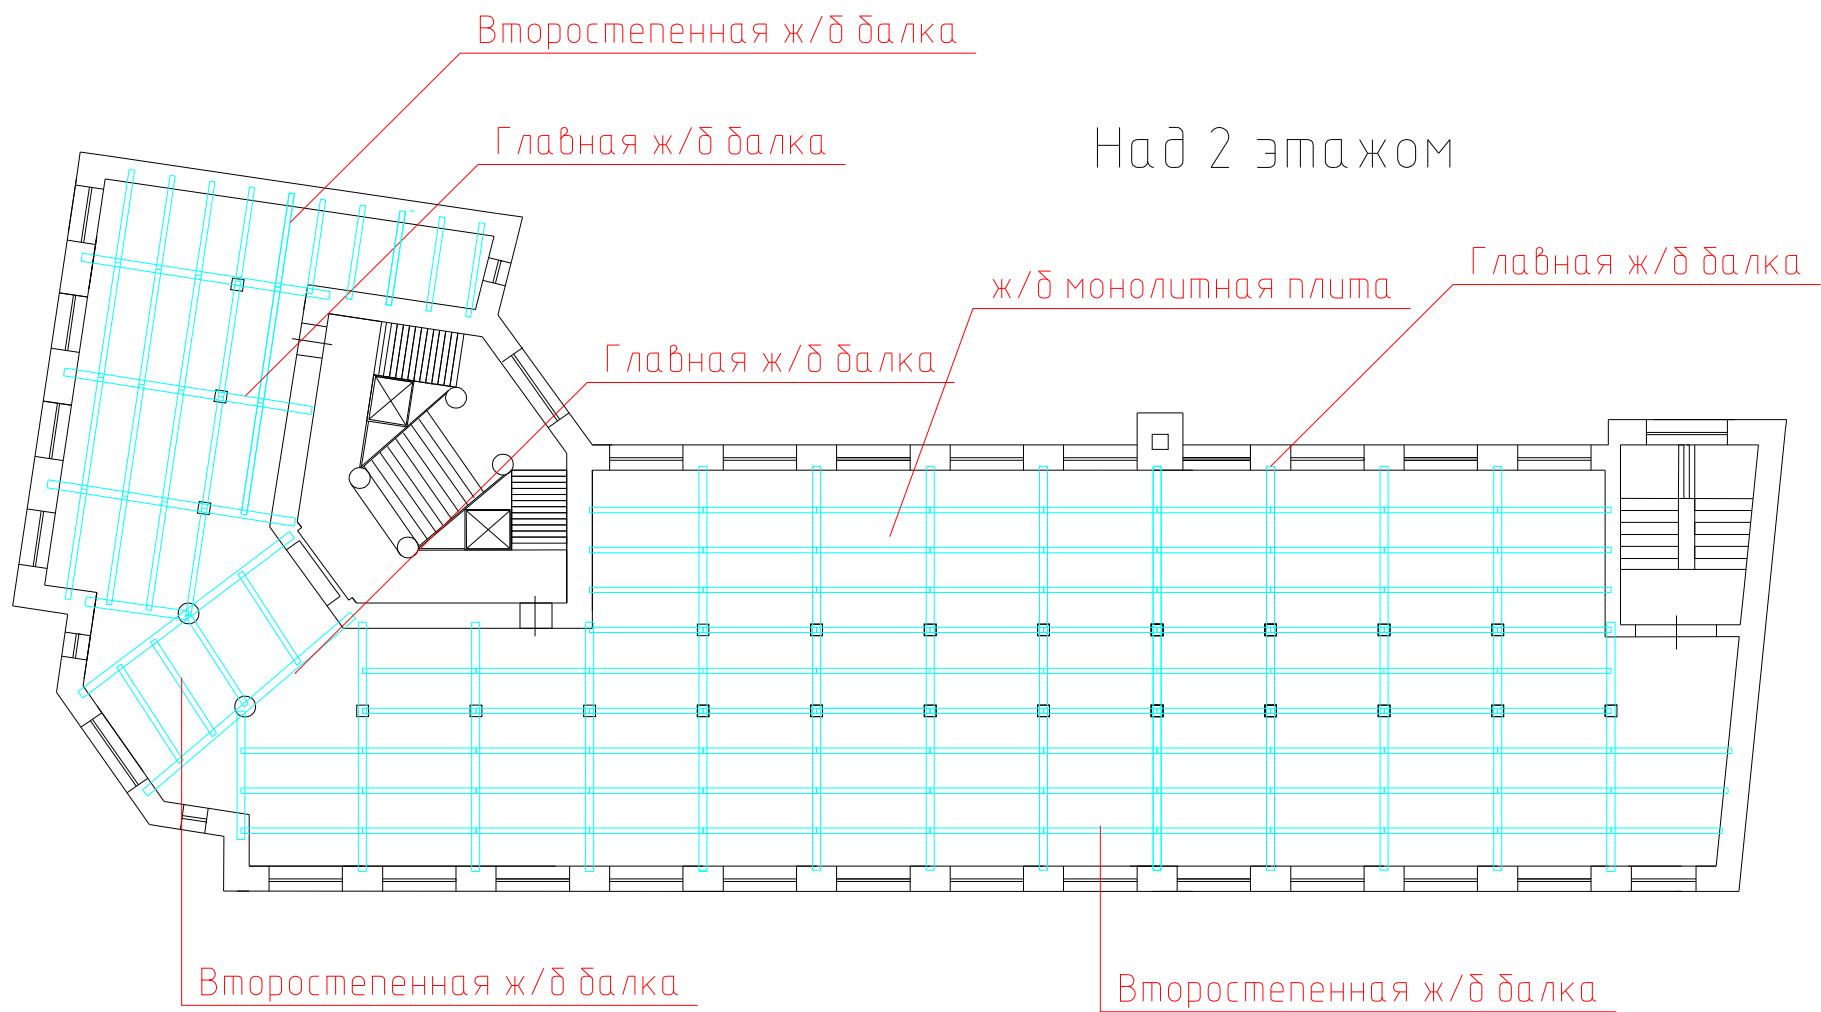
Схема главных и второстепенных балок монолитного перекрытия над вторым этажом
